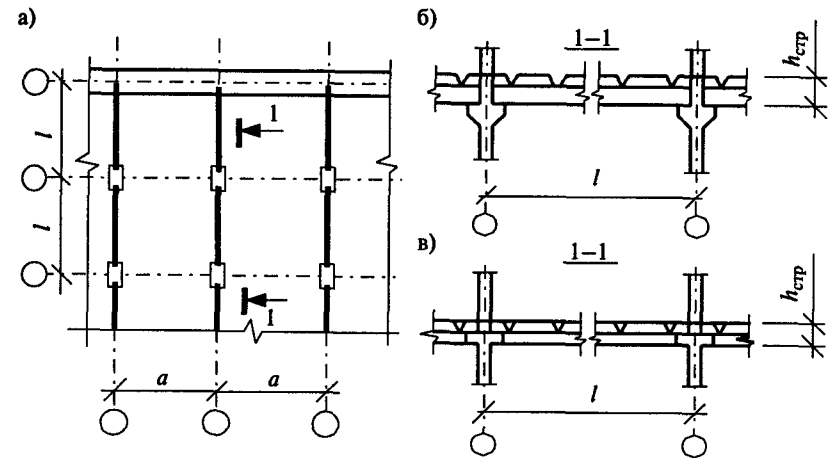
Участок плана и разрезы сборных железобетонных перекрытий: а) участок плана железобетонного перекрытия; б) разрез перекрытия с плитами, опирающимися на верх ригелей; в) разрез перекрытия с плитами, опирающимися на нижние полки ригелей
